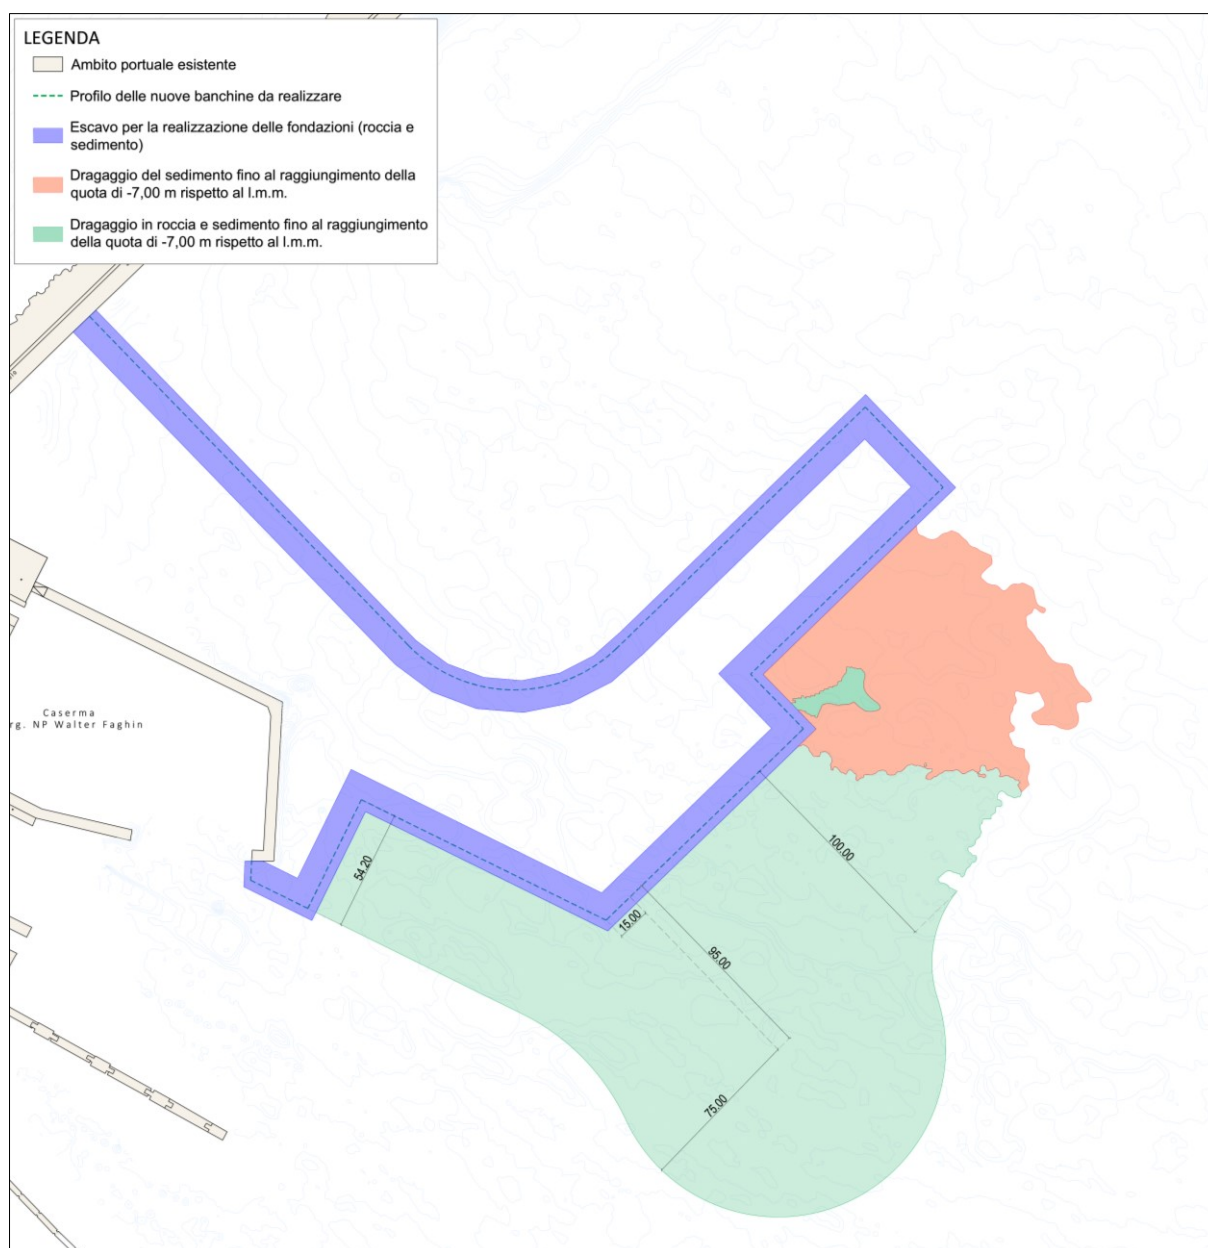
Planimetria del dragaggio (in blu è indicato l'escavo funzionale alla realizzazione delle fondazioni, in rosso il dragaggio del solo sedimento ed in verde il dragaggio in roccia)
